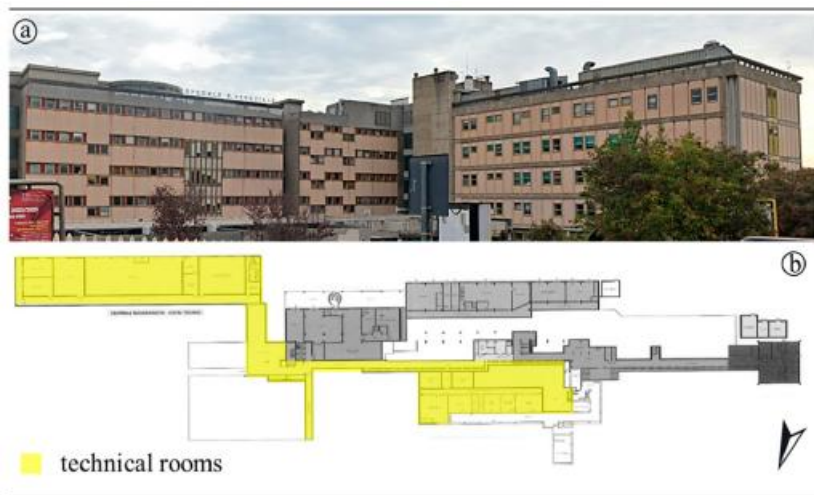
Ospedale 'Ferdinando Veneziale', vista esterna (a) e pianta del piano interrato -2 (b)
